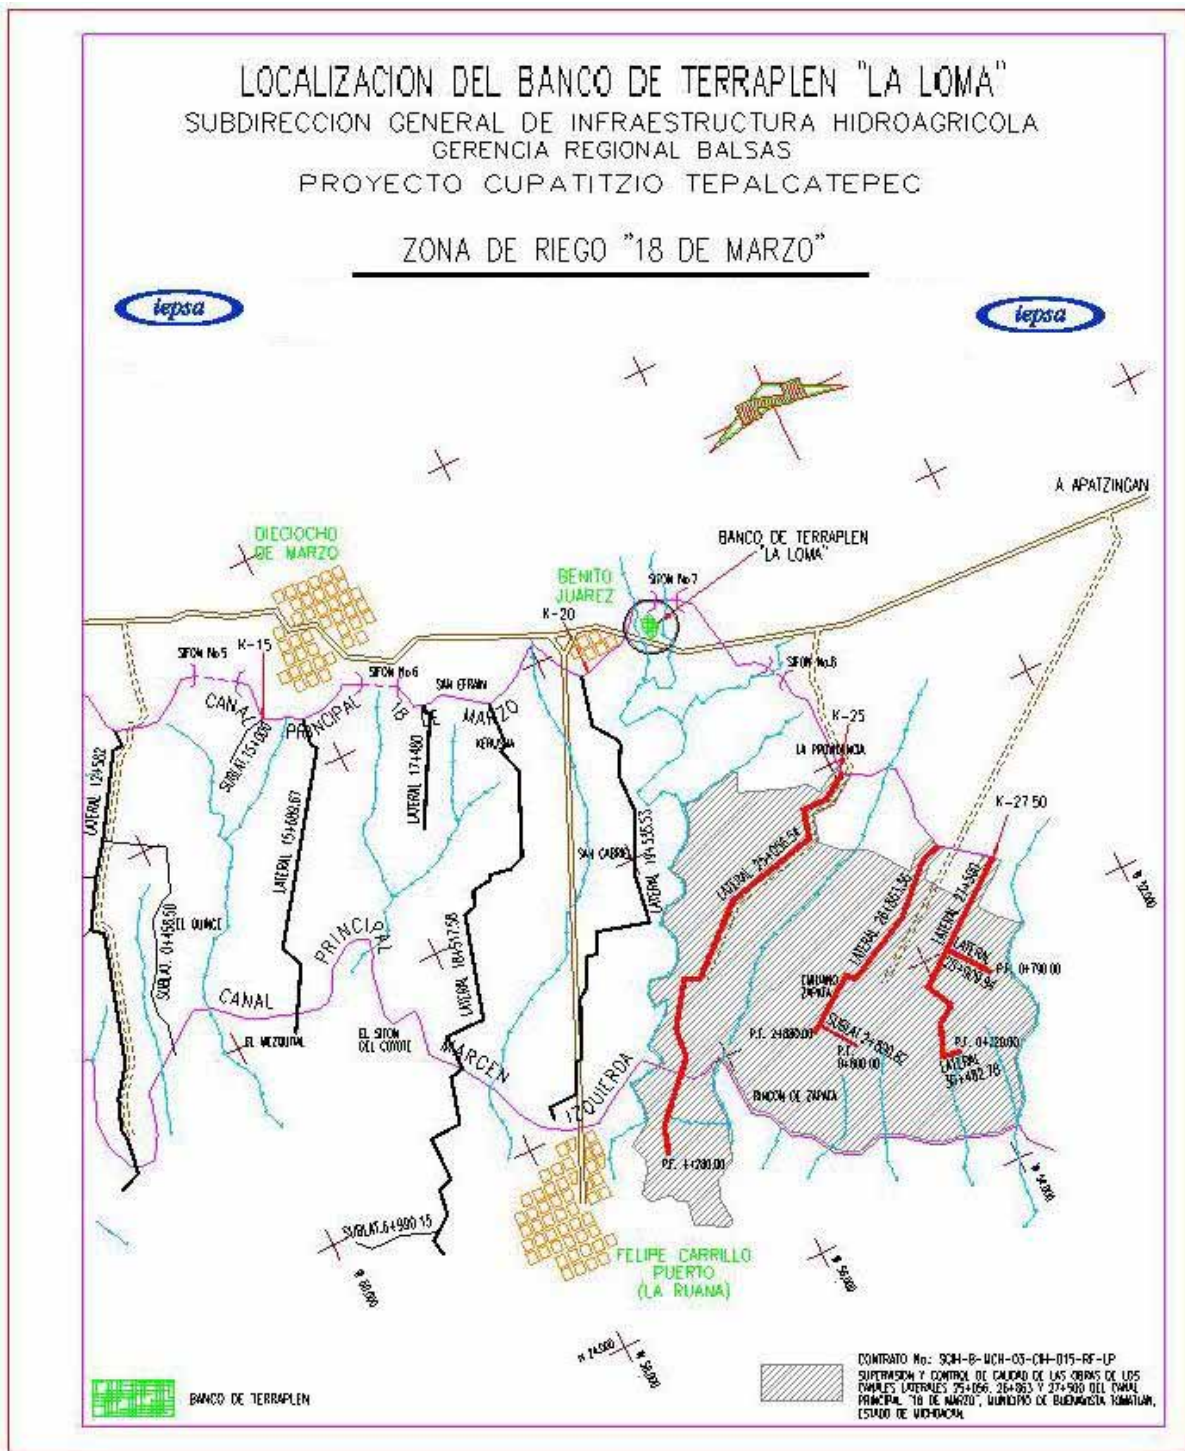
Banco de extracción de terraplén. "La Loma".
